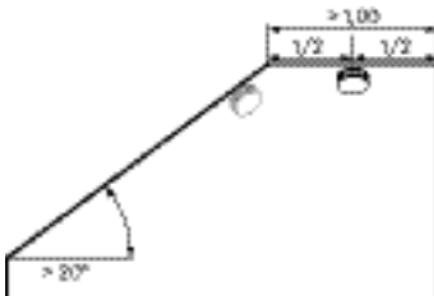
Surface de montage droite d'une longueur et d'une largeur d'au moins 1 m
